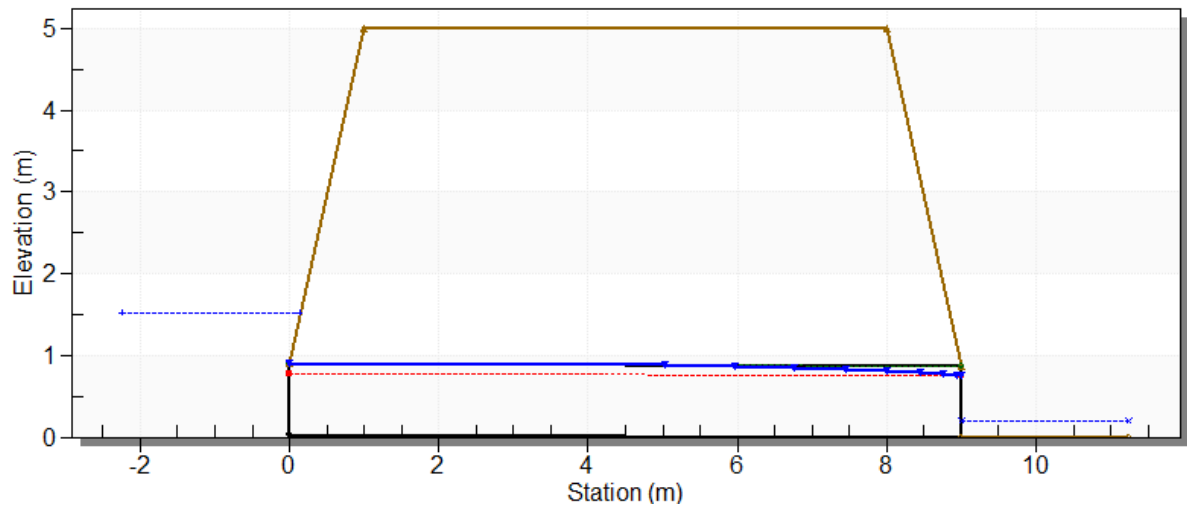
Desing Culvert. Metal corrugado 900 mm
